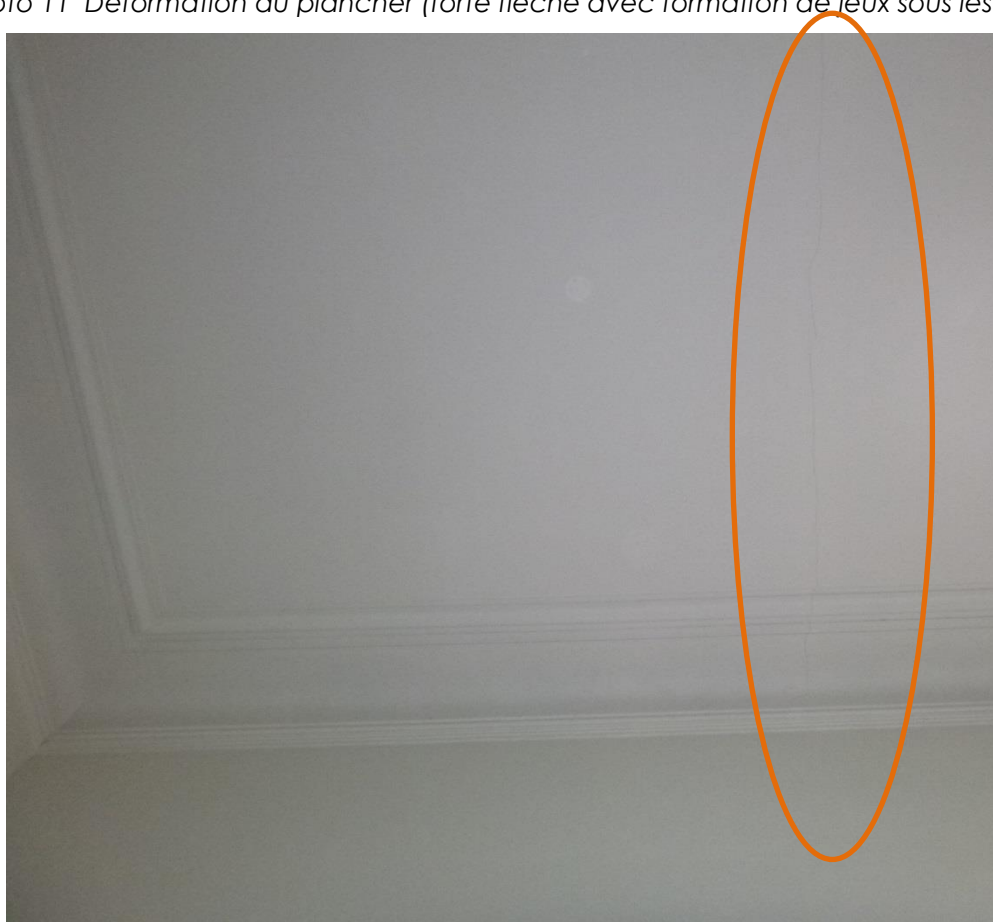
Fissuration du plafond de la salle 0.4
